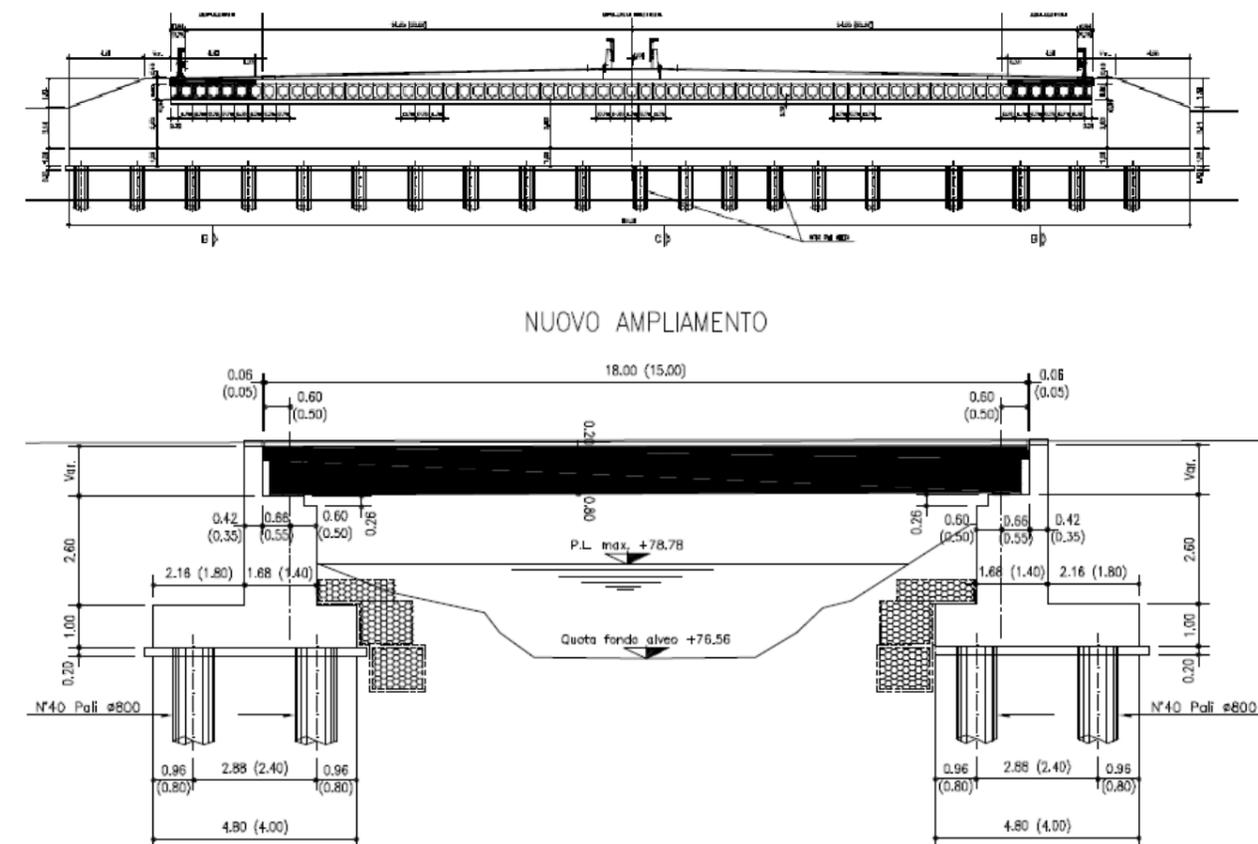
Cavo Sillaro - Sezione trasversale e longitudinale
